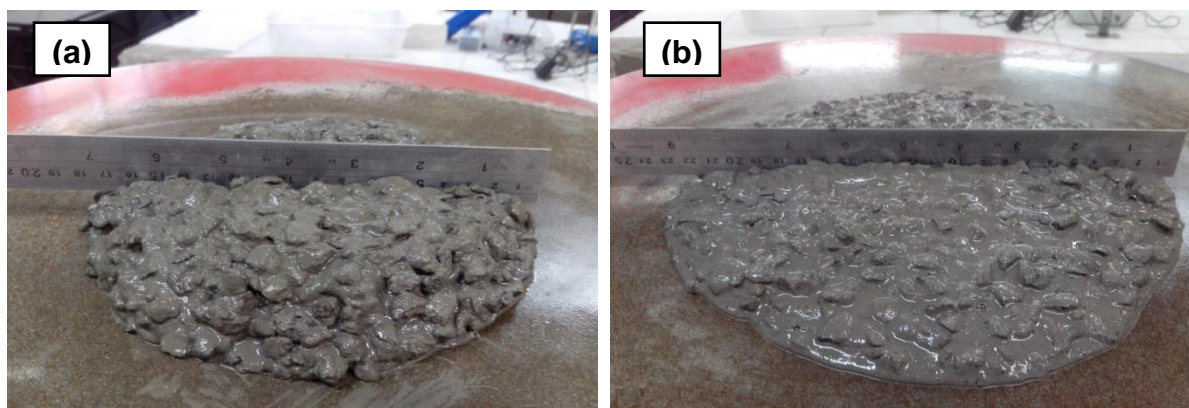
Verificação do espalhamento de concretos. (a) Concreto à base de CP; (b) Concreto à base de CAT.
